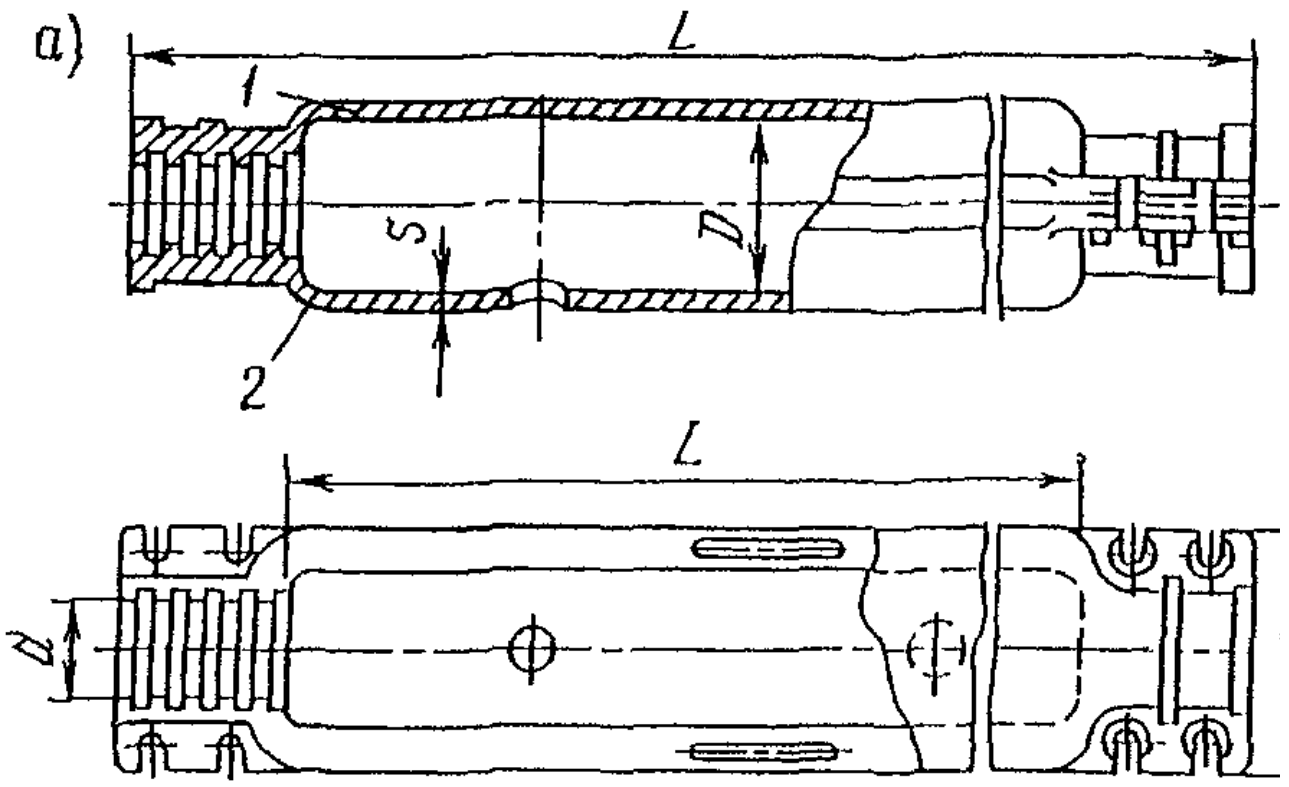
Свинцовая труба и соединительная муфта для кабелей напряжением 6 и 10 кВ: а - свинцовая труба; б - свинцовая муфта; 1 - проволочные бандажи; 2 - провод заземления; 3 - корпус муфты из свинцовой трубы; 4 - заливочное отверстие; 5 - подмотка рулонами; 6 - бандаж роликами с лентой шириной 10 мм; 8 - подмотка роликами с лентой шириной 5 мм; 9 - гильза соединительная
